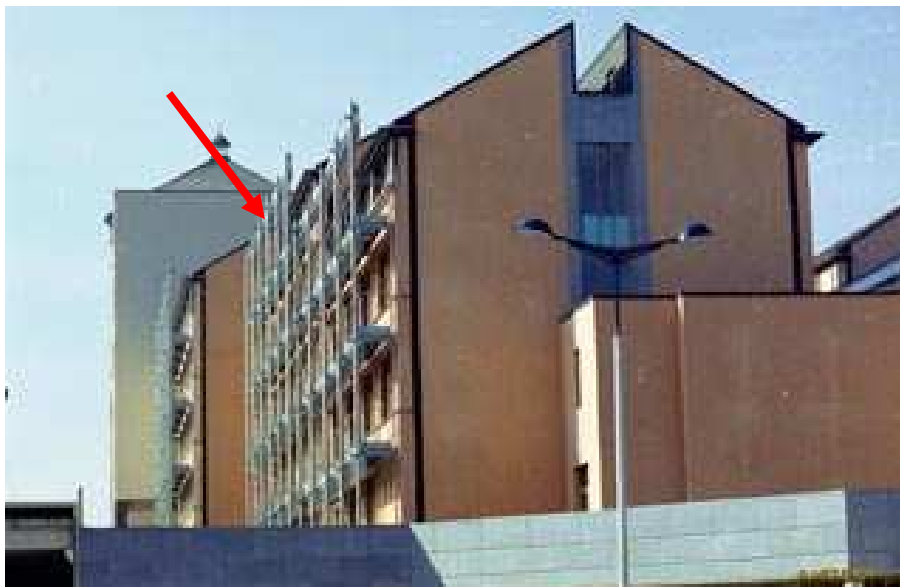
PROTECTIONS SOLAIRES DE LA FAÇADE SUD⁹
